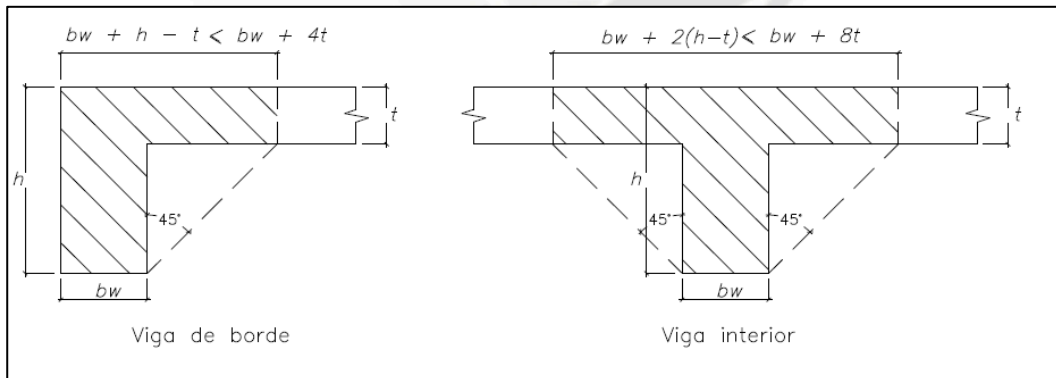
Ejemplos de la porción de losa que debe considerarse para el cálculo de
